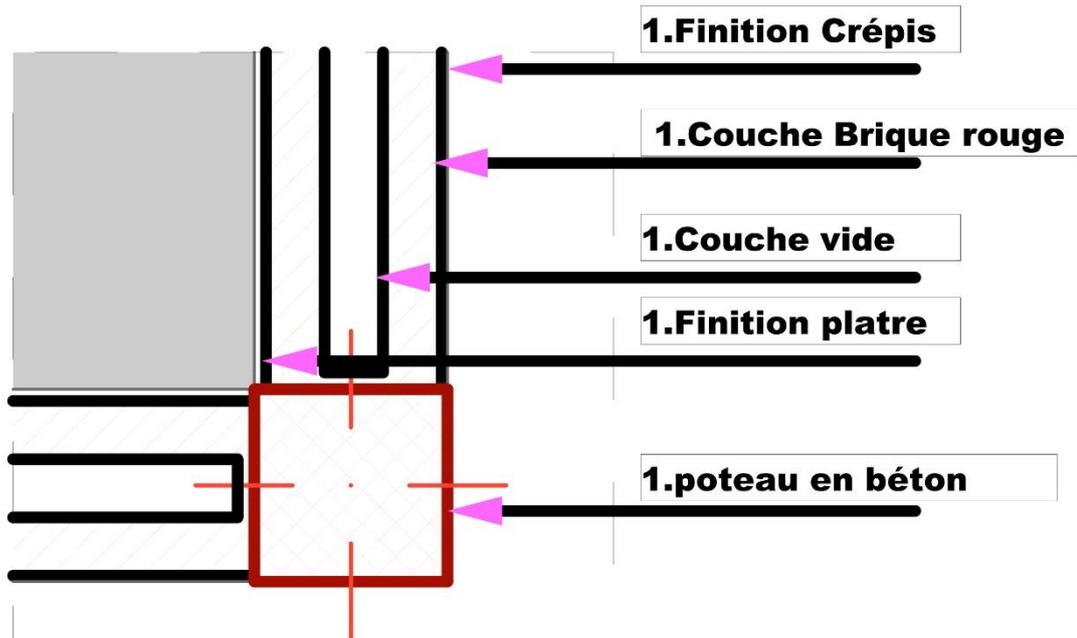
Détail angle du mur (Source : modéliser sur Archicad)
